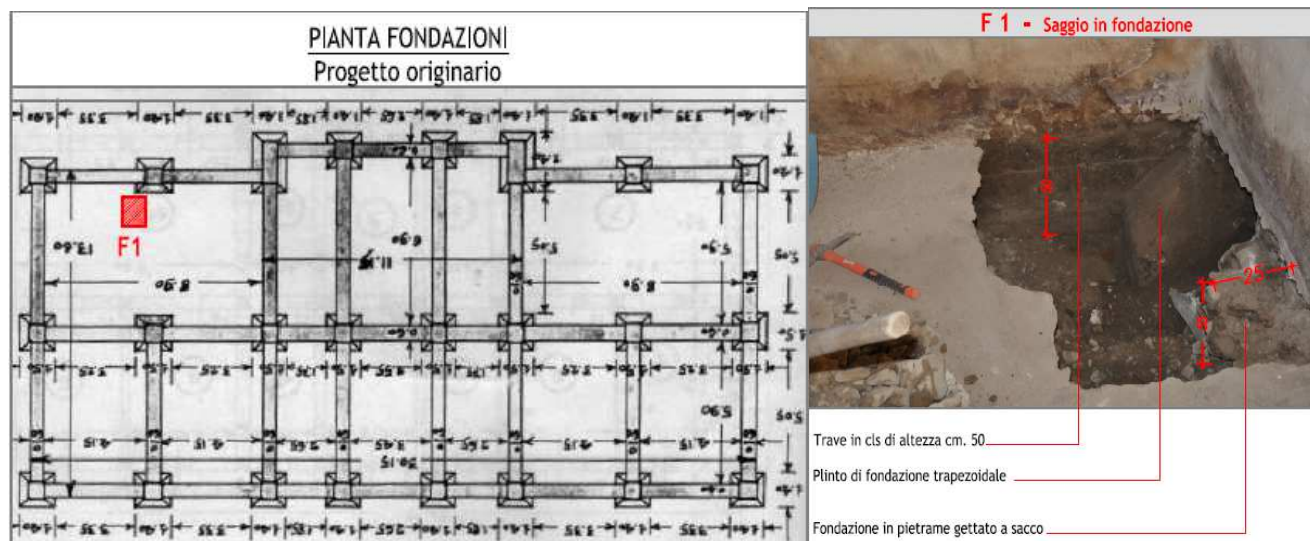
Ubicazione e risultato del rilievo delle strutture di fondazione in corrispondenza del muro di controvento aggiunto.
